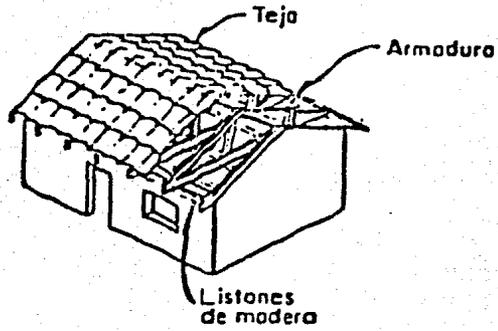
VIVIENDAS TÍPICAS DE ADOBE
